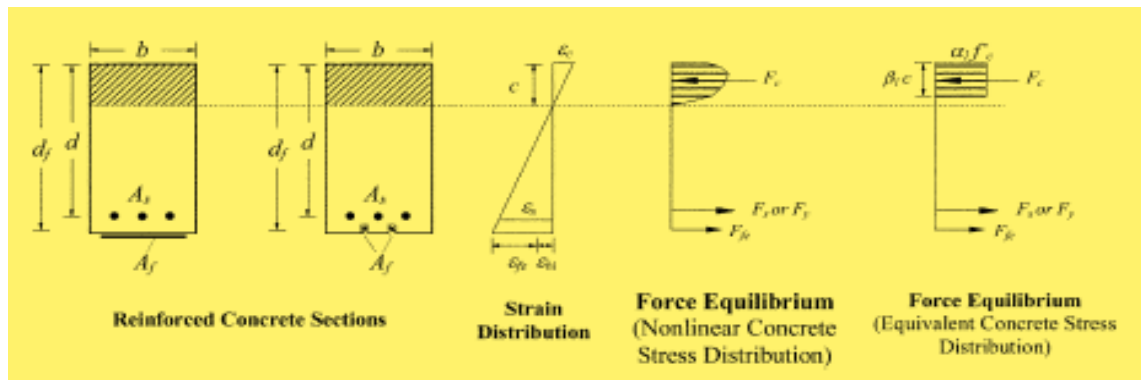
La Tensión y la Distribución de Tensiones Internas para Sección Rectangular Bajo flexión límite último
